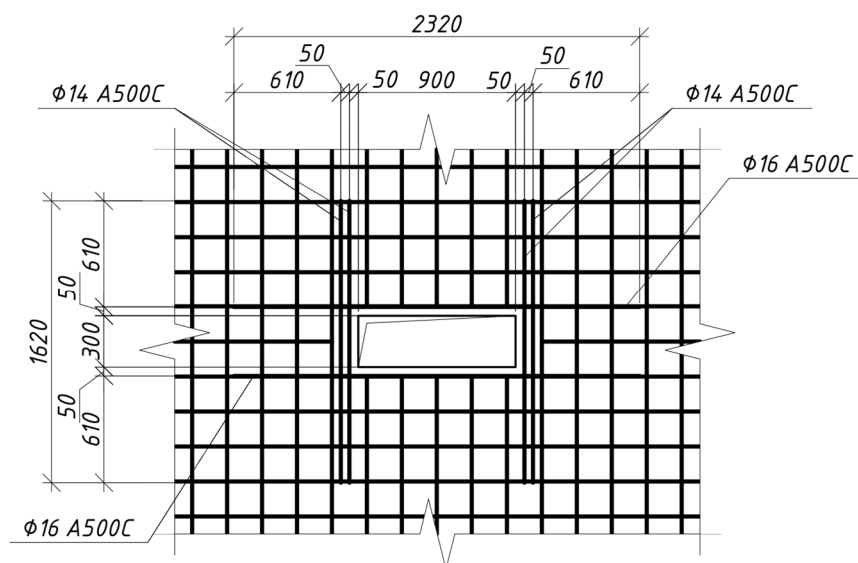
Схема обрамлення отворів у плиті перекриття
